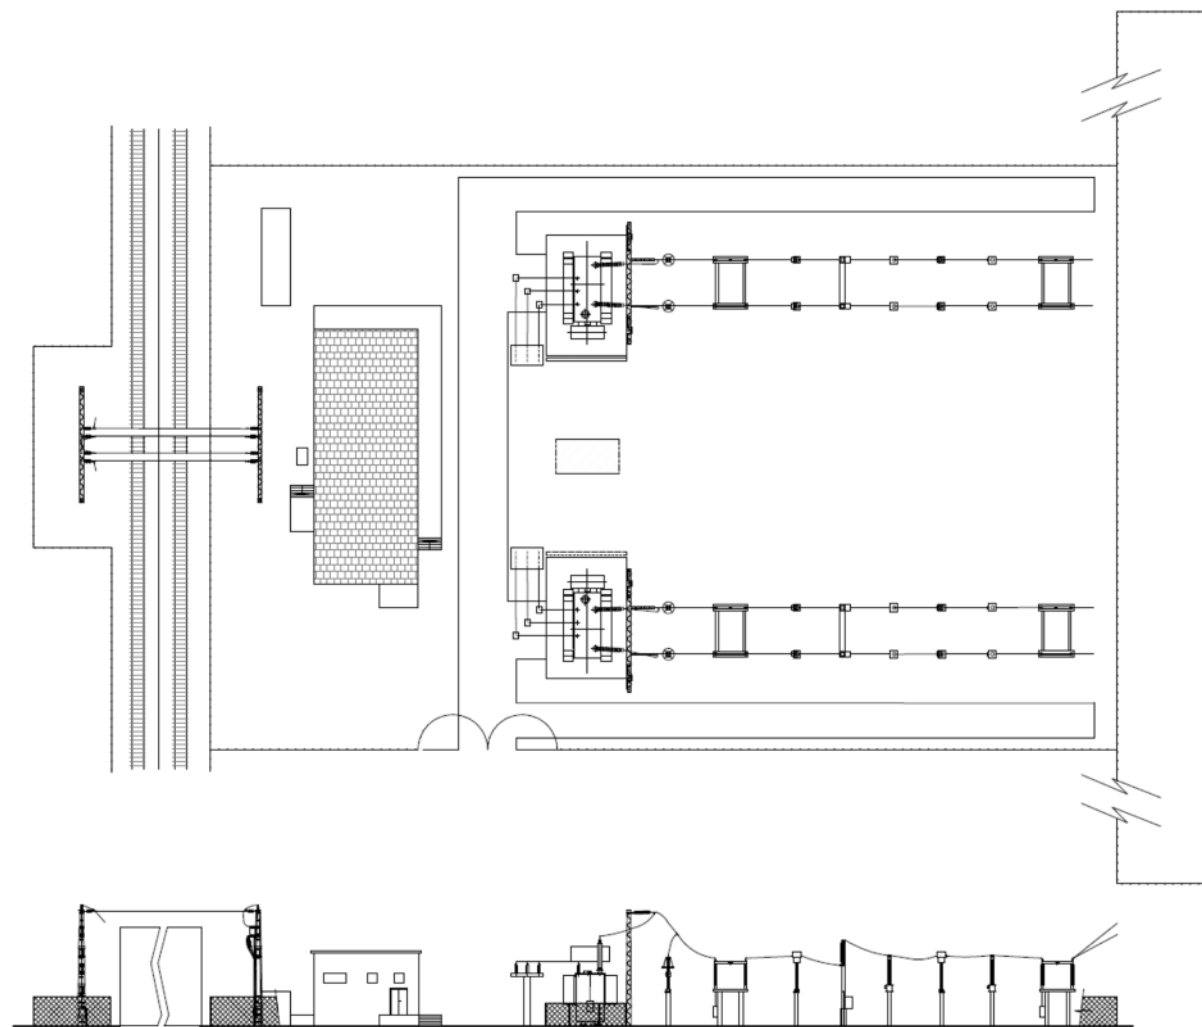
Subestación de tracción. Planta y alzado del parque (Fuente: Plano 11.6 del Anejo nº 11, Electrificación,
